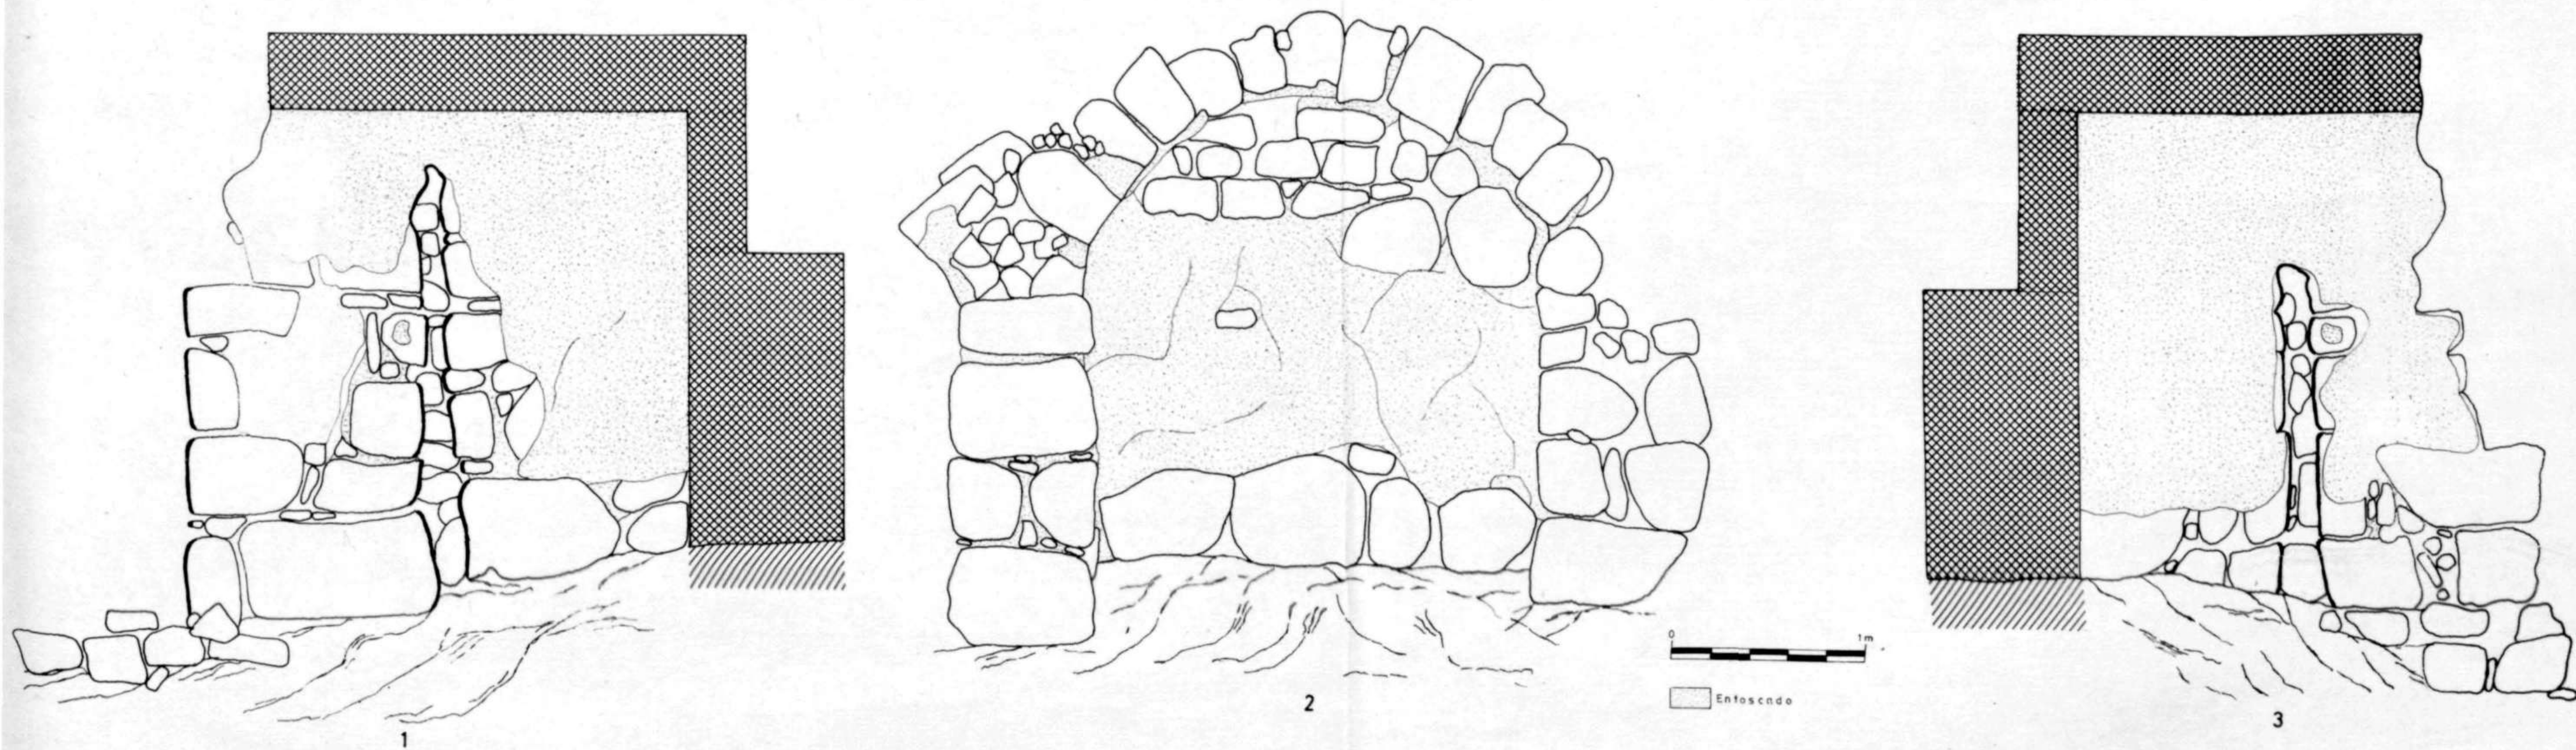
Baño caliente, alzado de los muros. 1) muro norte; 2) muro este; 3) muro sur.
